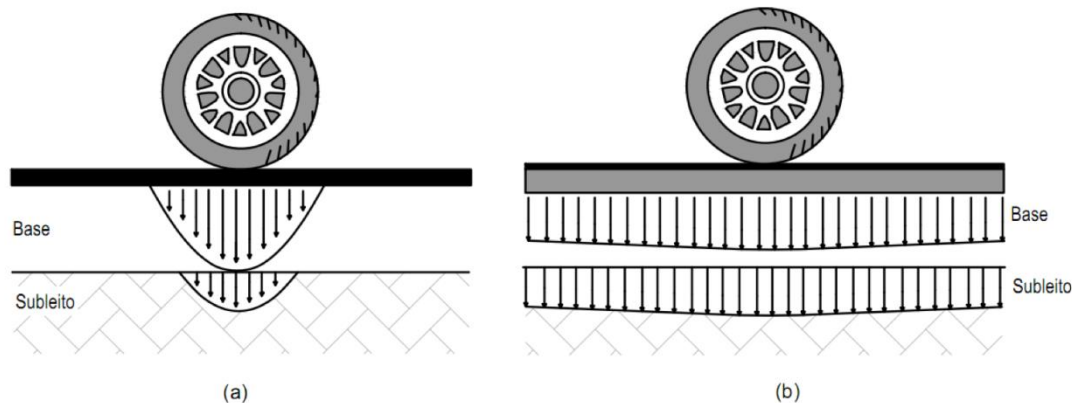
(a) campo de tensões de pavimento flexível; (b) campo de tensões de pavimento rígido (adaptado de BALBO, 2007, p. 47)
